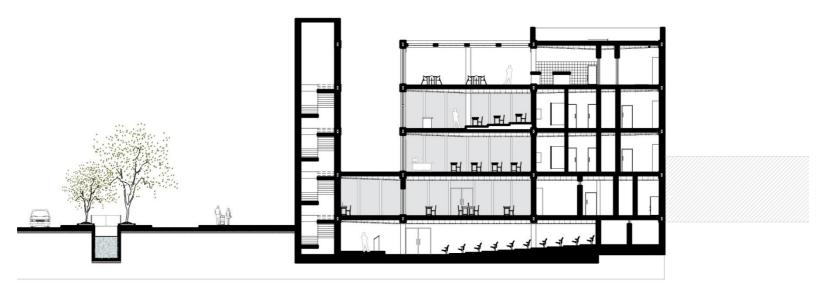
Corte transversal 1 Fuente: elaboración propia
